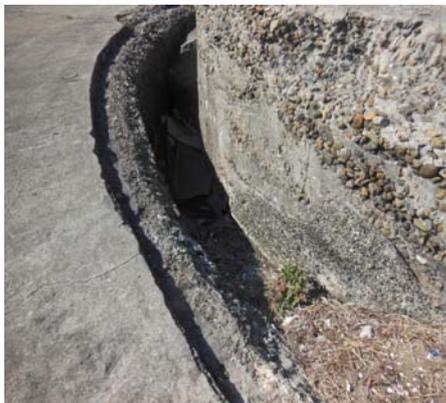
15cm 加農砲塔砲台③の砲台本体と巻立てコンクリート
